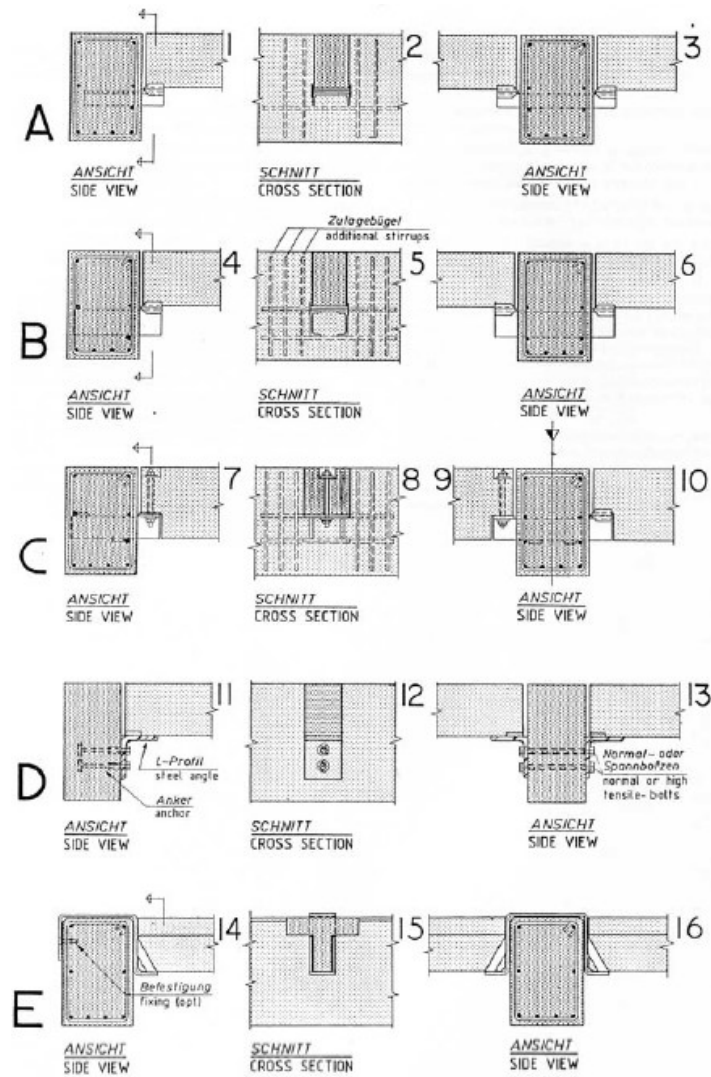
Ligação por consolo metálico (Stupré, 1981)
